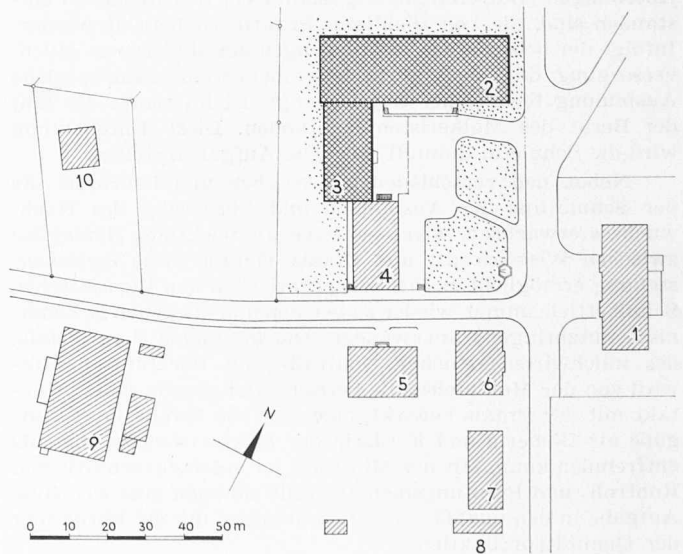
Lageplan der Molkereischule Rütli, Zollikofen, 1:2000. 1 Konviktsgebäude, 2 Neues Betriebsgebäude, 3 Zwischengebäude mit Wärmезentrale und Tiefkühlanlage, 4 Werkstattgebäude, 5 Schulgebäude, 6 Alter Käsespeicher mit Wohnungen, 7 Garagen, 8 Treibhaus und Gemüsegarten, 9 Schweinestallungen, 10 Werkführerwohnhaus
